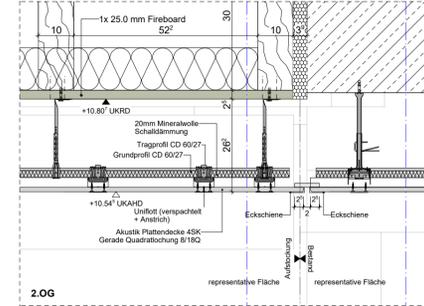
Decke 2 - Längsschnitt Wandanschluss
